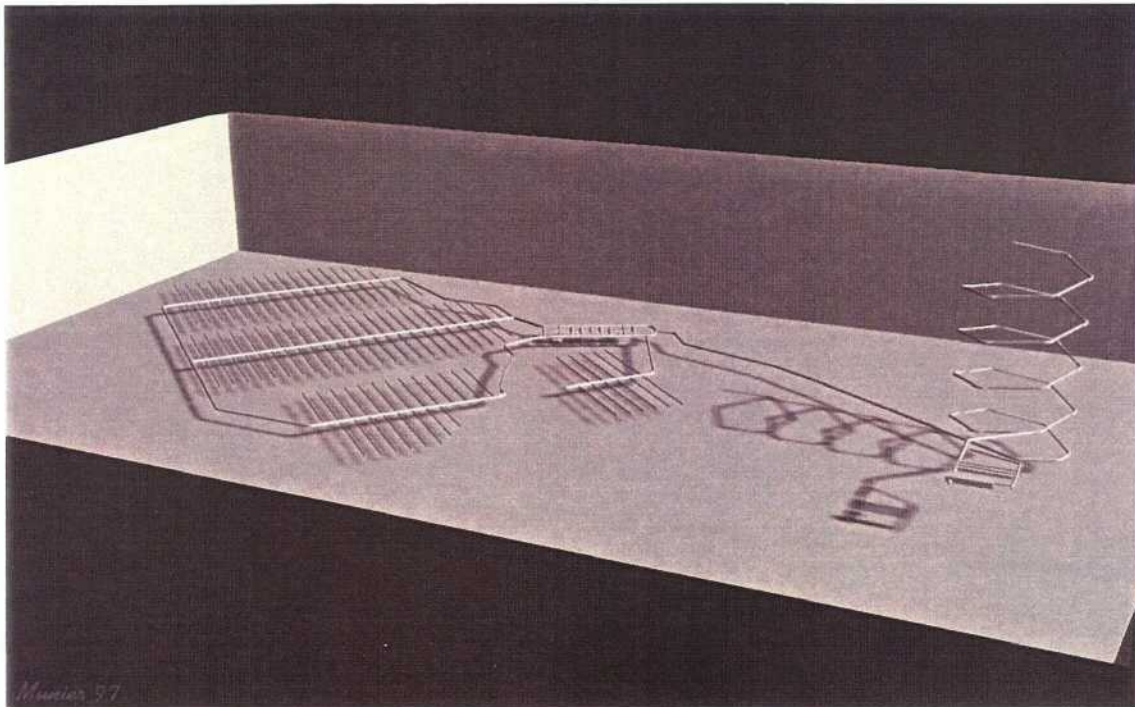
Ceberg layout B. Deponeringstunnlar är orienterade parallellt med σ_1 .
